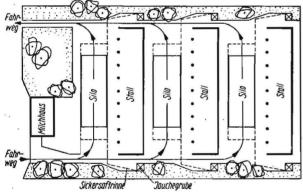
Lageplan einer Offenstallanlage für 180 Milchkühe
